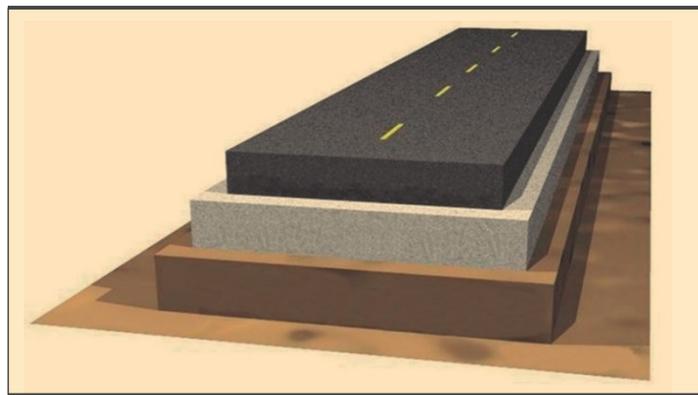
Sección transversal de un pavimento flexible (Muench 2006).
